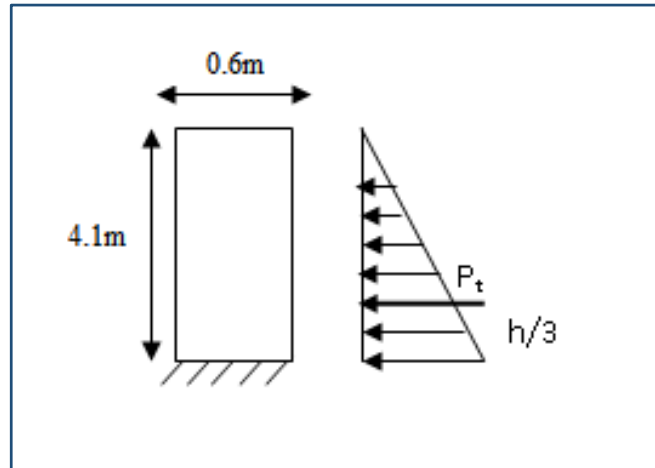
Poussée des terres sur le mur garde-grève.
